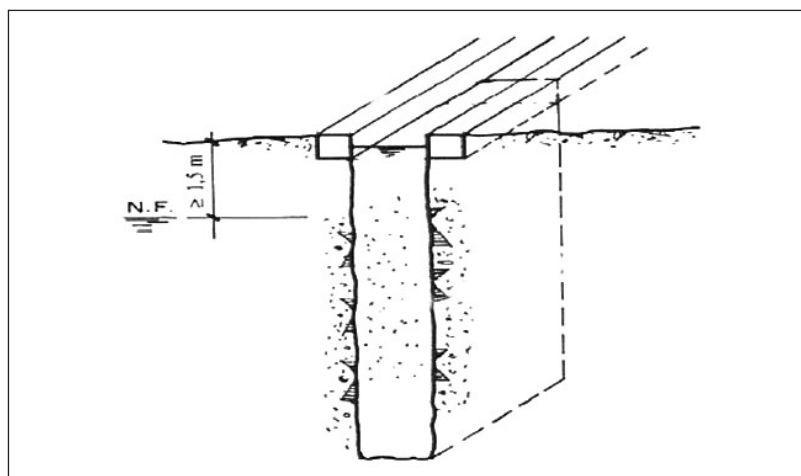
CIMENTACIÓN MEDIANTE PANTALLAS EN PILAS.
